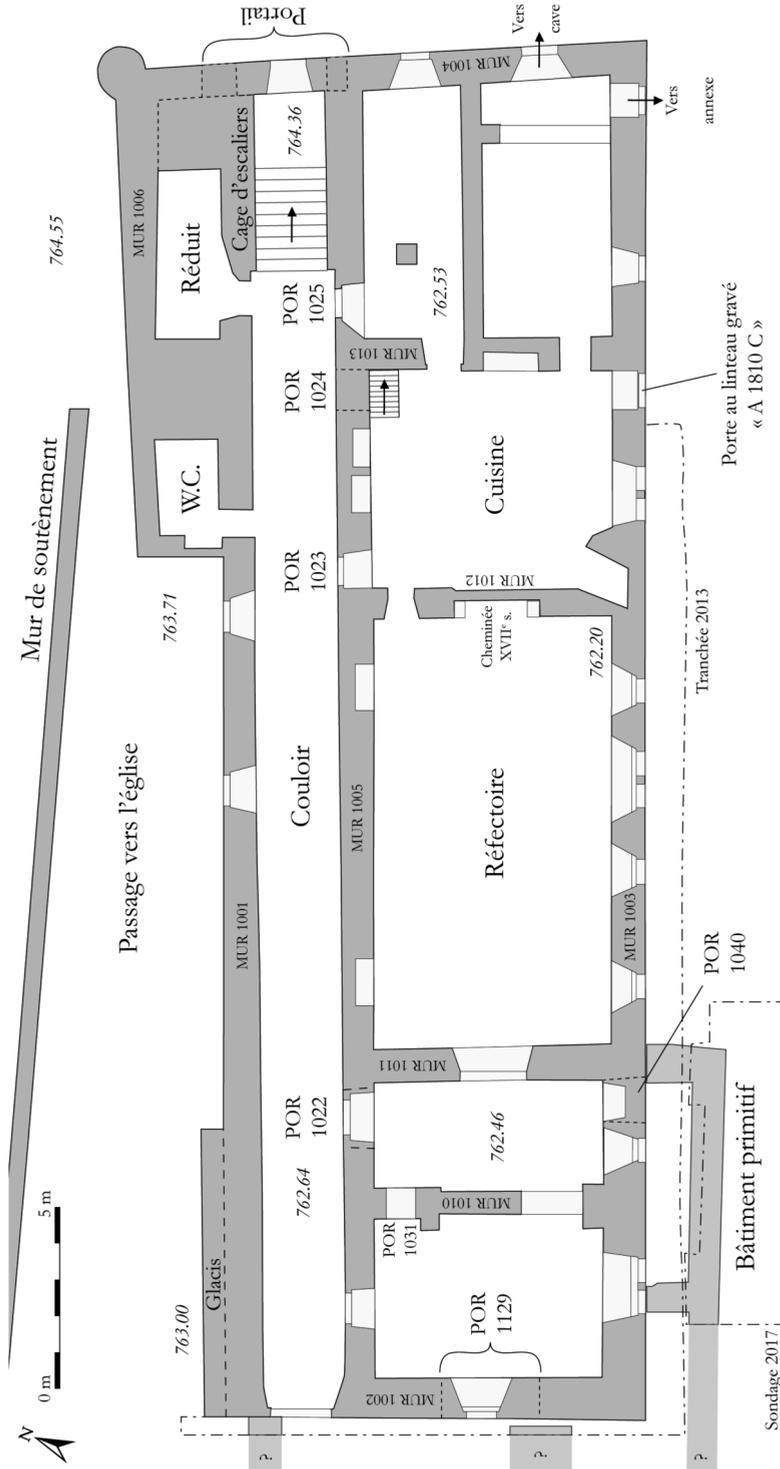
Plan de l'aile sud des anciens bâtiments conventuels
